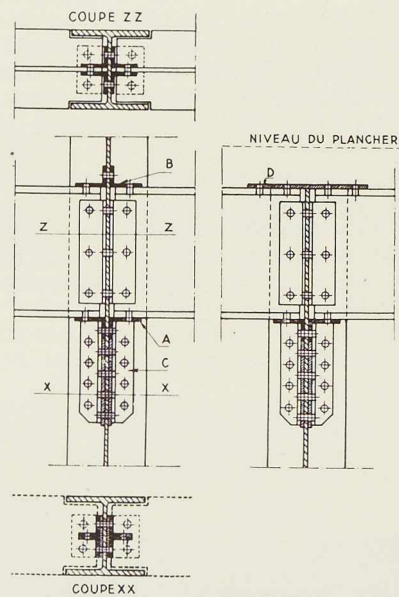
Détail d'un assemblage entre poteau et entretoise.
